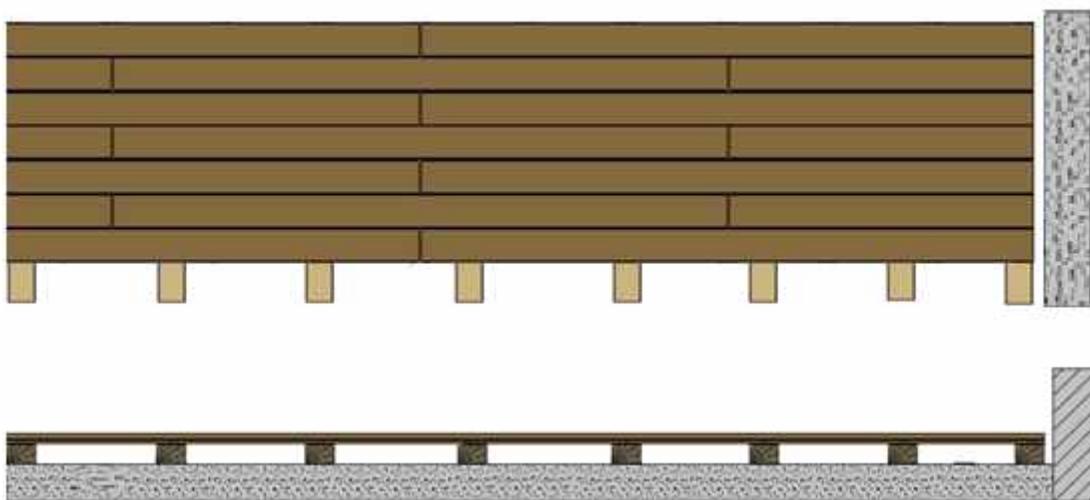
Possibile schema di posa di un pavimento in legno per esterni (decking) su elementi di supporto trasversali (magatelli) fissati ad un massetto cementizio.
